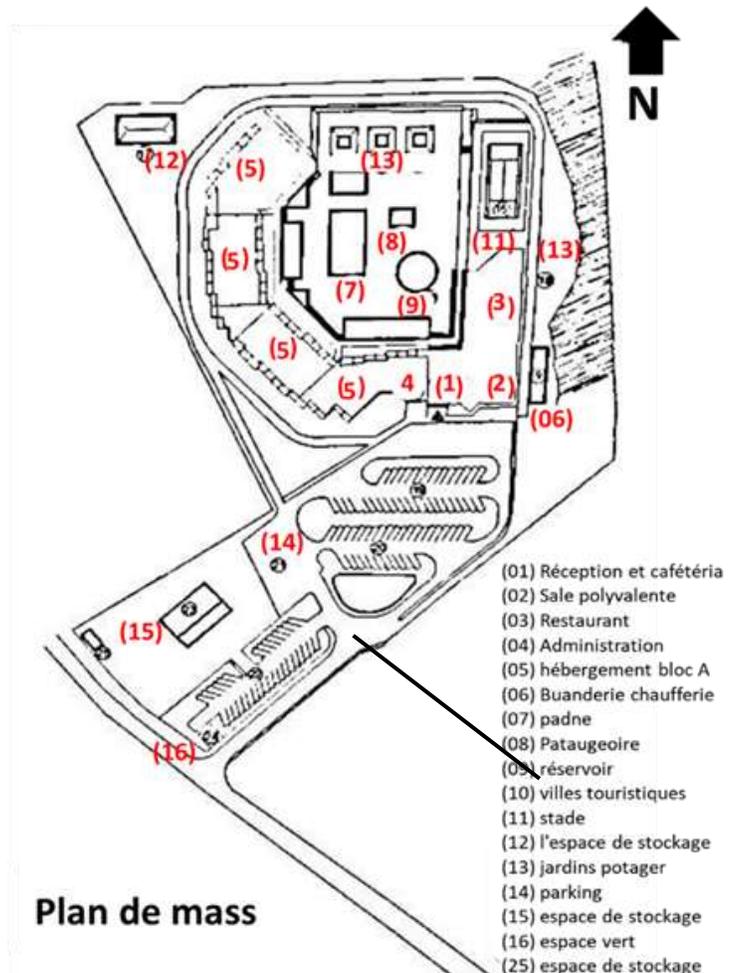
le plan de masse qu'a prévu l'investisseur avant la construction (source : Auteur)
